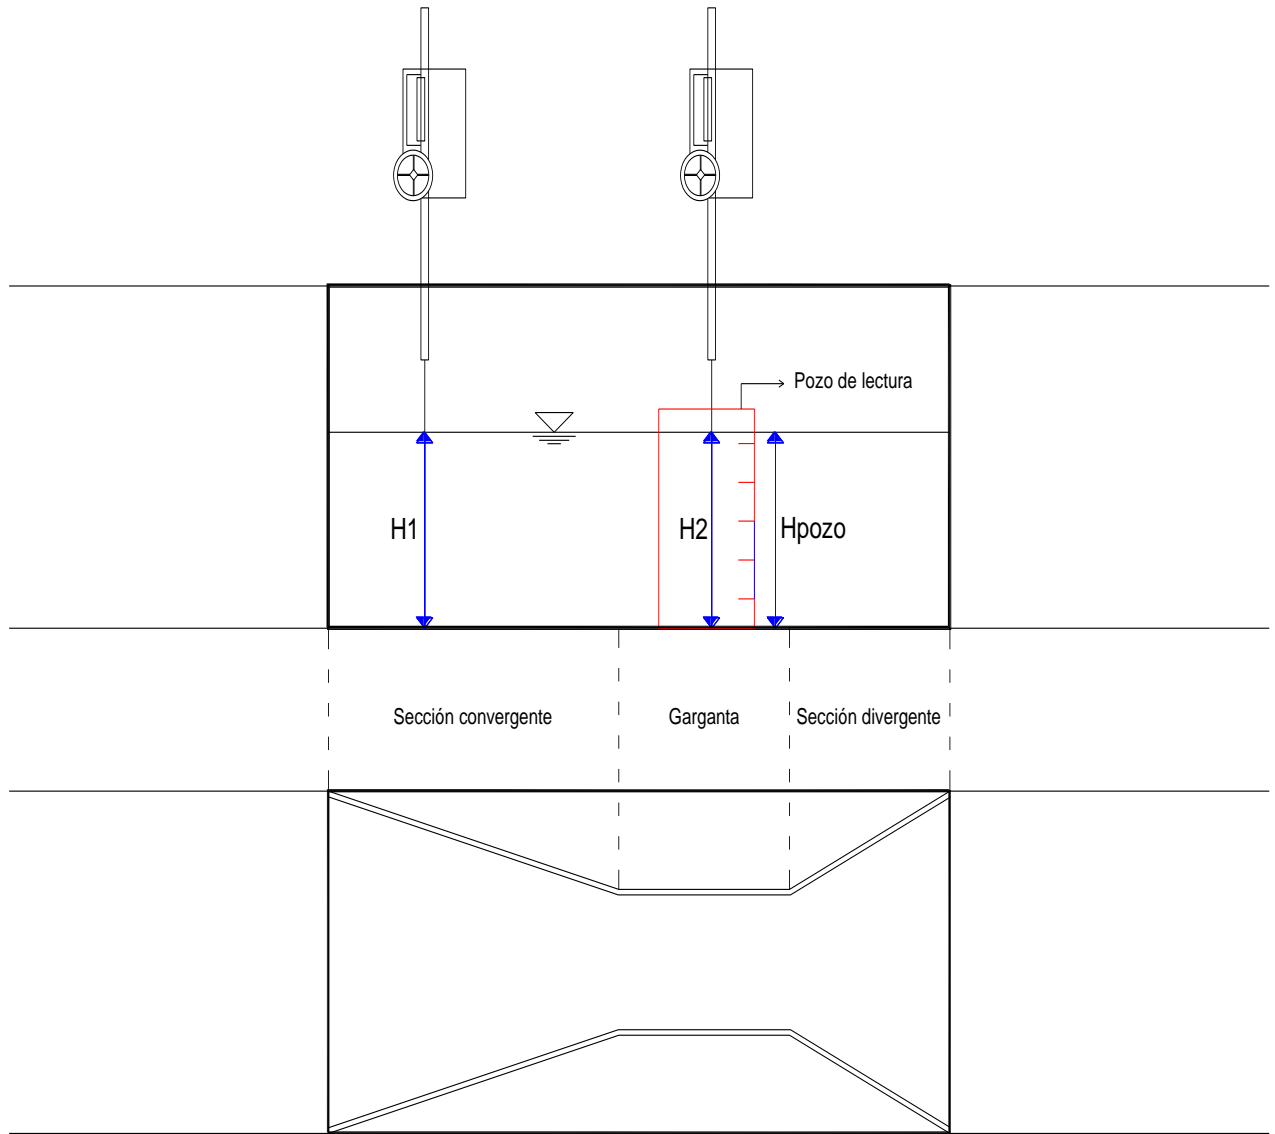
Esquema para la ubicación en planta y perfil de los tirantes en el aforador Parshall.
